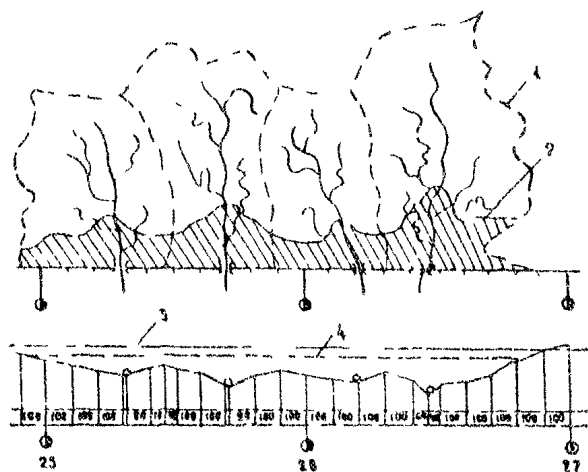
Схема группового расположения водопропускных сооружений при их водостойкой аккумуляции: 1-граница оросения; 2-граница разлива при аккумуляции; 3-бровка земляного полотна; 4-РГББ.
